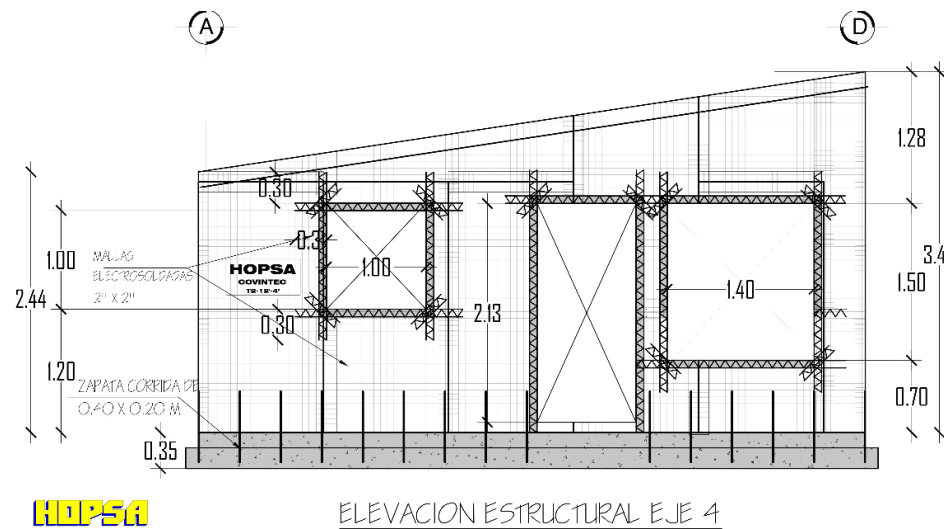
Elevación Estructural Principal de Vivienda Valles de Sandino.
